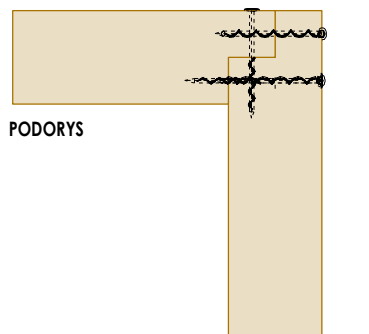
DETAIL K - ULOŽENIE PIEVLAKU BSH
